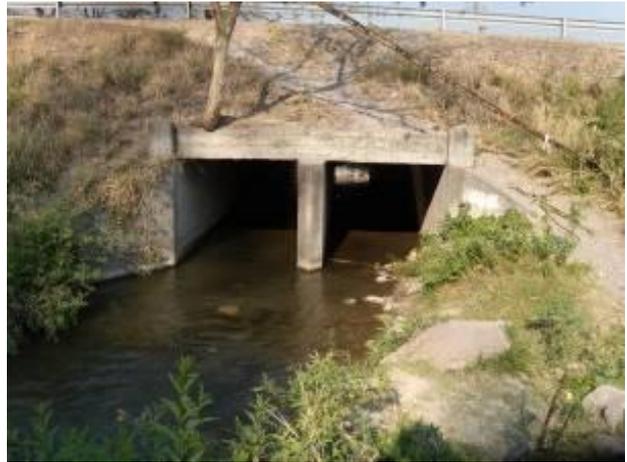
Entrada de la alcantarilla de cruce bajo la calzada principal
